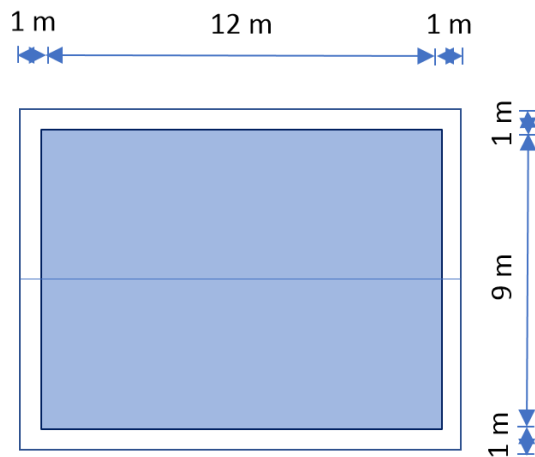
Beispiel Abriss eines Einfamilienhauses – Grundriss
